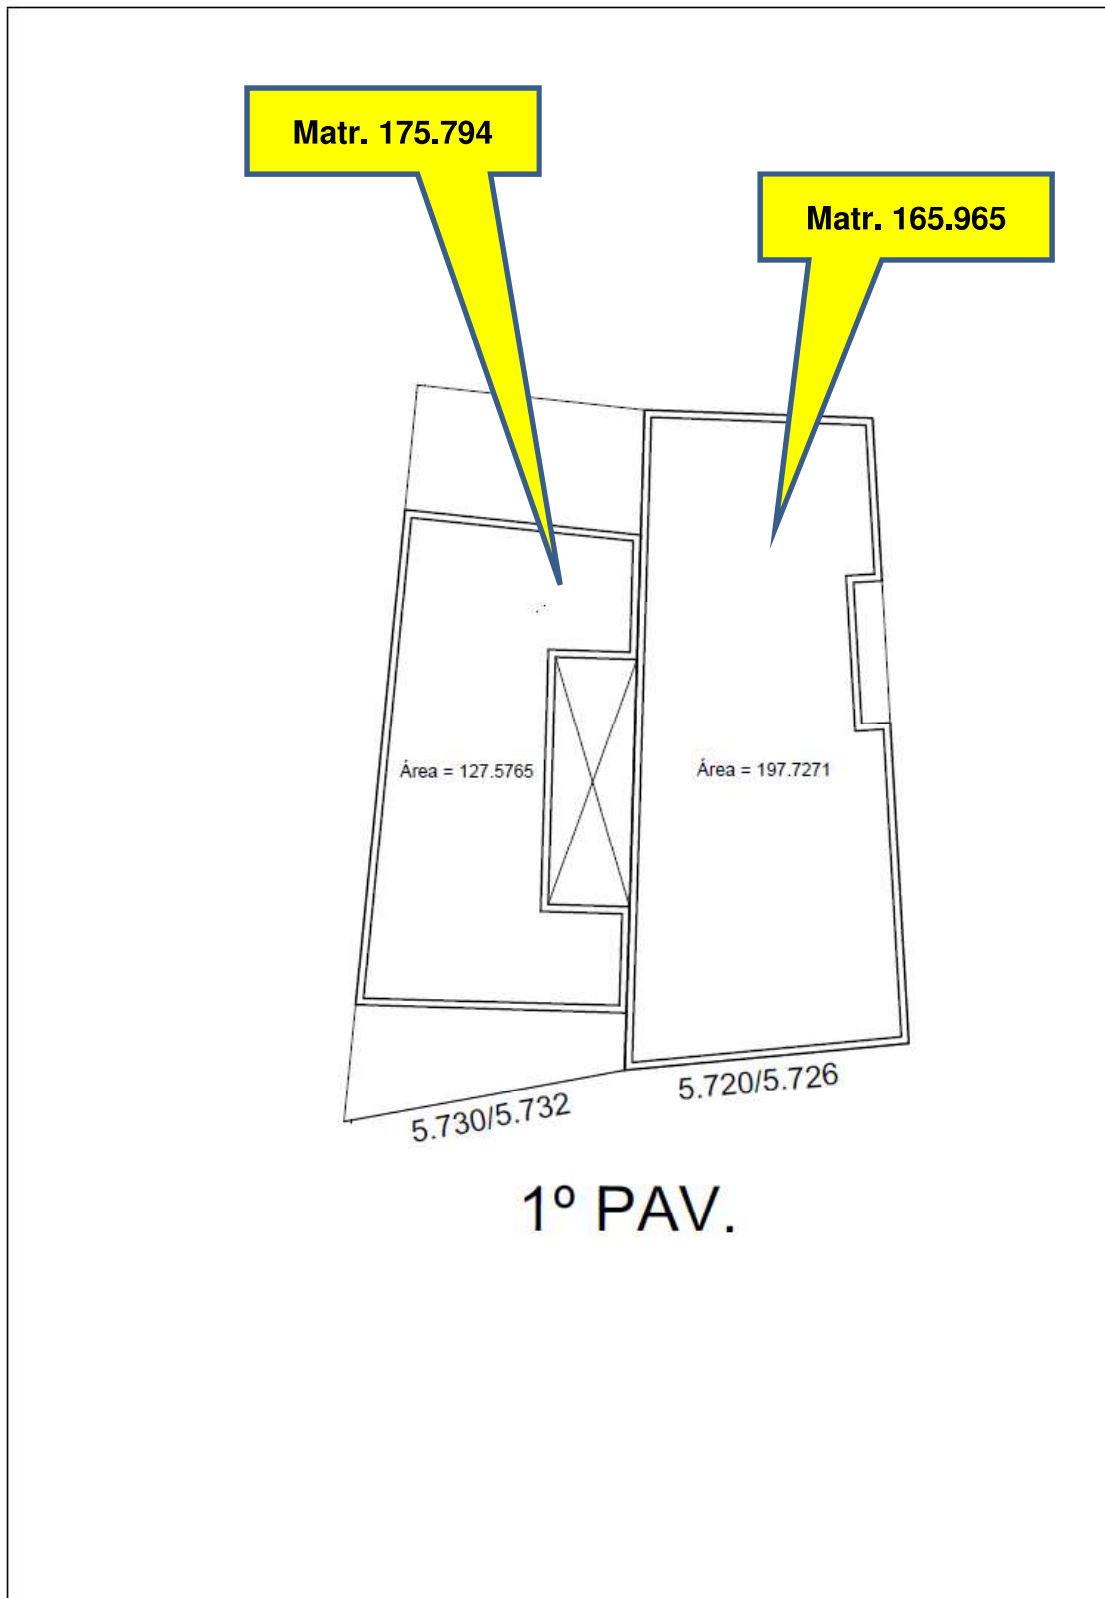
Croquis do 1º pavimento dos Imóveis sob Matrículas nºs 175.794 e 165.965 – 14º CRI.
